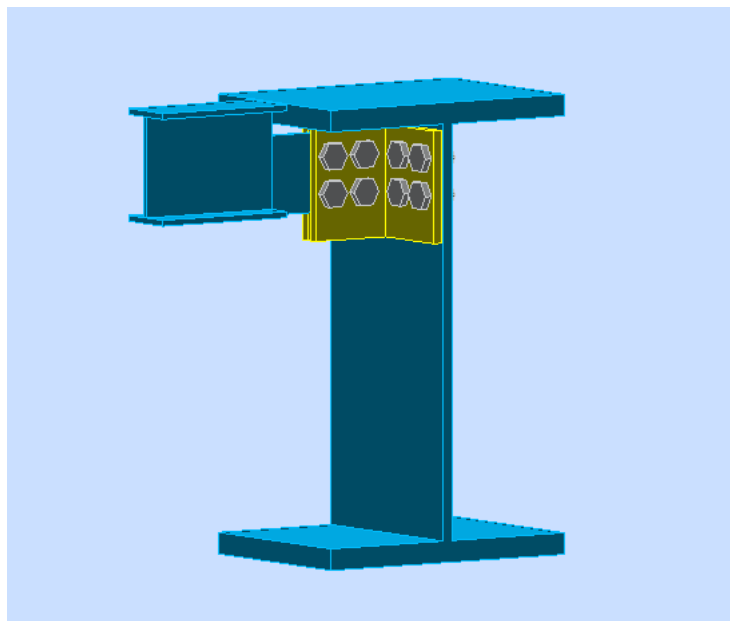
Assemblage poutre-solive (HEA500-IPE120)
